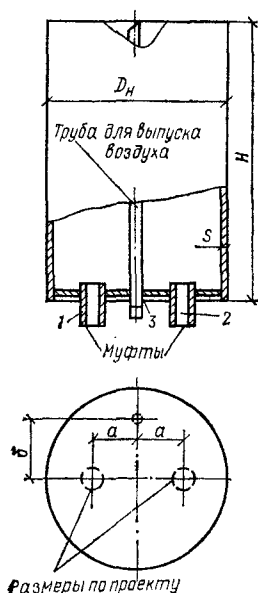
Вертикальный проточный воздухоотборник ВС-1
